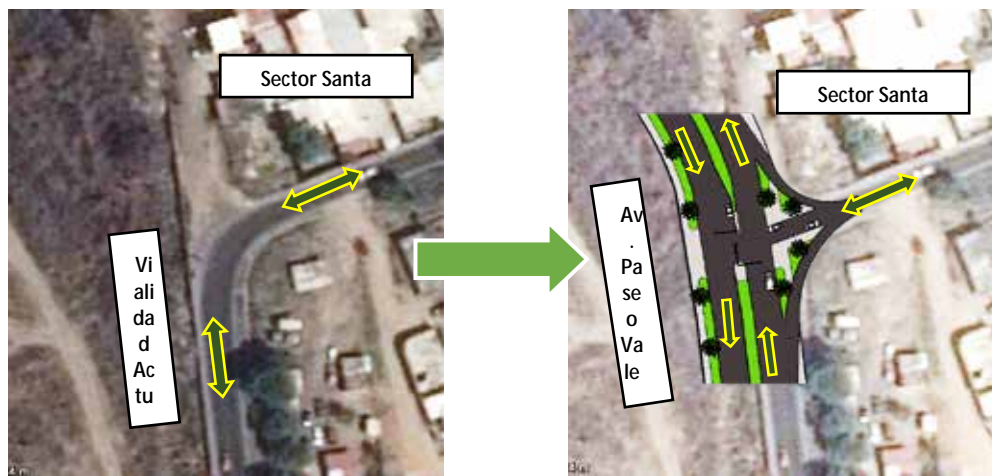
Intersección actual y propuesta para el Paso hacia el Sector Santa Inés II.
